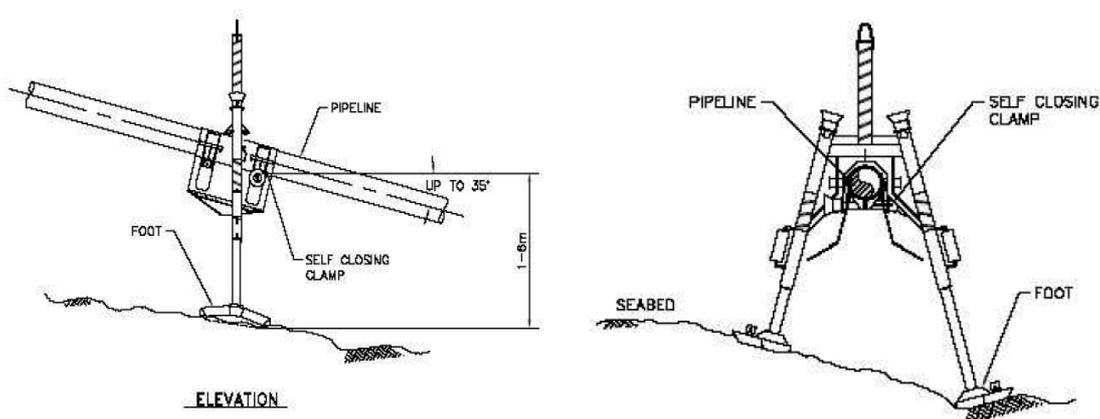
Vistas lateral e frontal de um suporte mecânico instalado.
